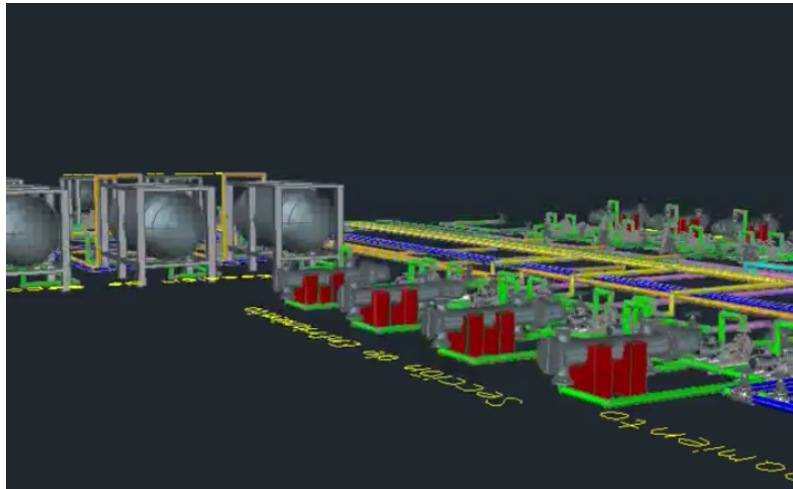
Vistas de la planta en AutoCAD 3D.
